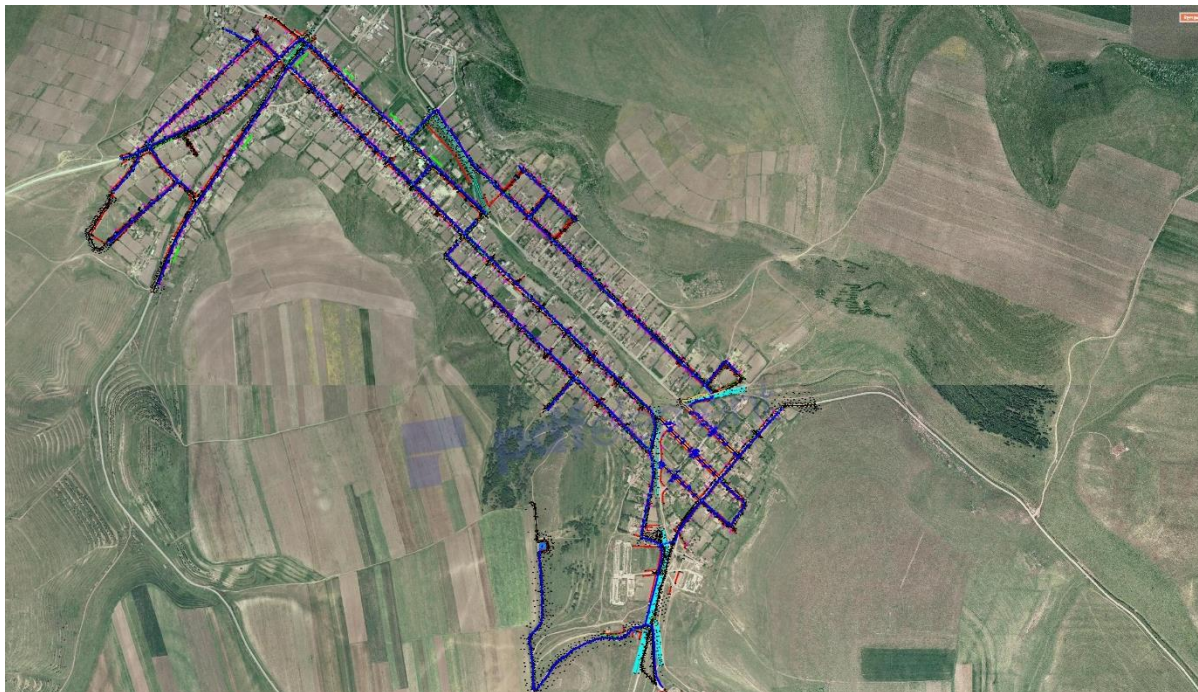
Plan de încadrare în zona a proiectului de modernizare rețea de alimentare cu apă
